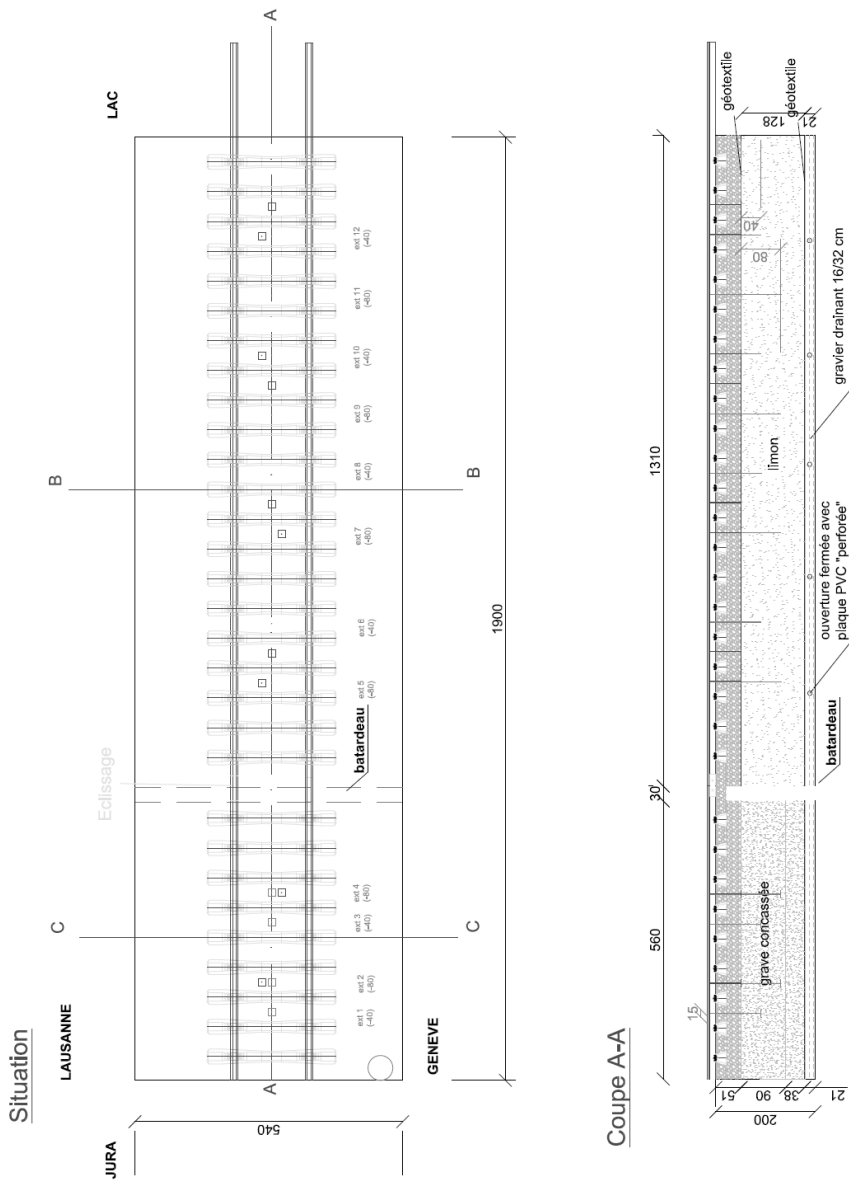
Plan et coupe longitudinale de la Halle Fosse du LAVOC, avec sections
